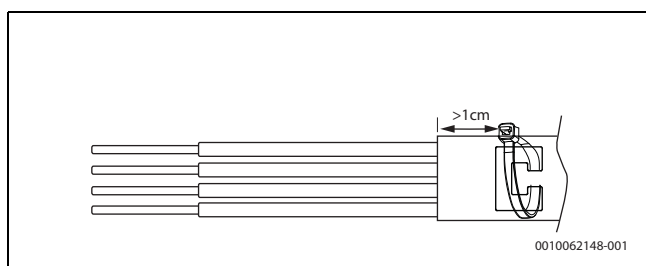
Fissaggio dello scarico della trazione sul cavo
